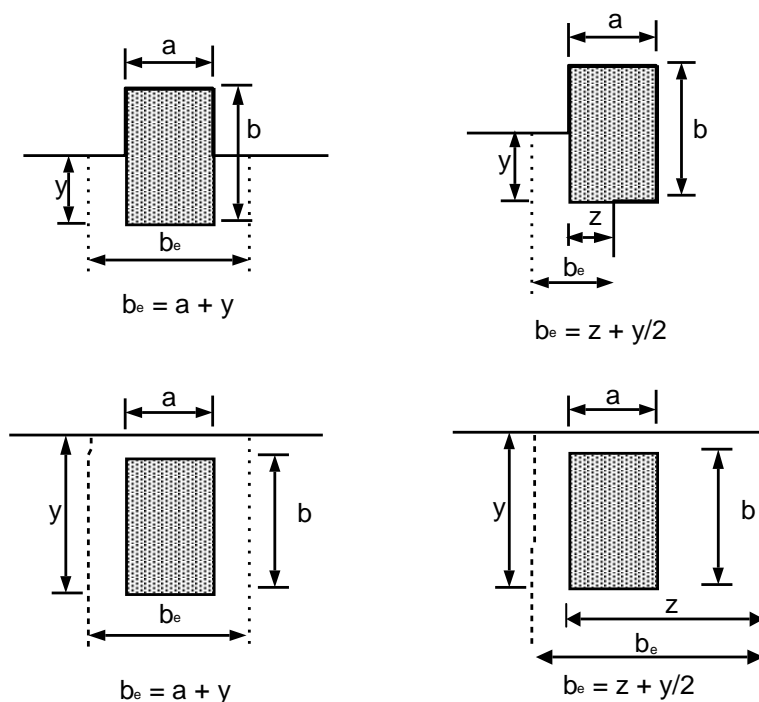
Planchers-dalles – Poteaux de rive et d'angle
